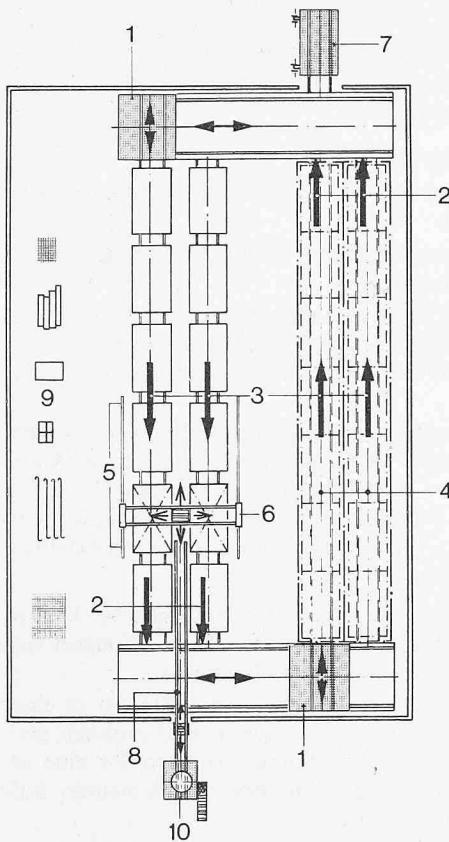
links. Horizontale Fabrikation im Paletten-Umlaufsystem. 1 Schiebebühne, 2 Transporteinrichtung, 3 Langtransport, 4 Gleisschienen, 5 Betonierstation, 6 Betonverteiler, 7 Kipptisch, 8 Kübelbahn, 9 Materiallager, 10 Mischstation
